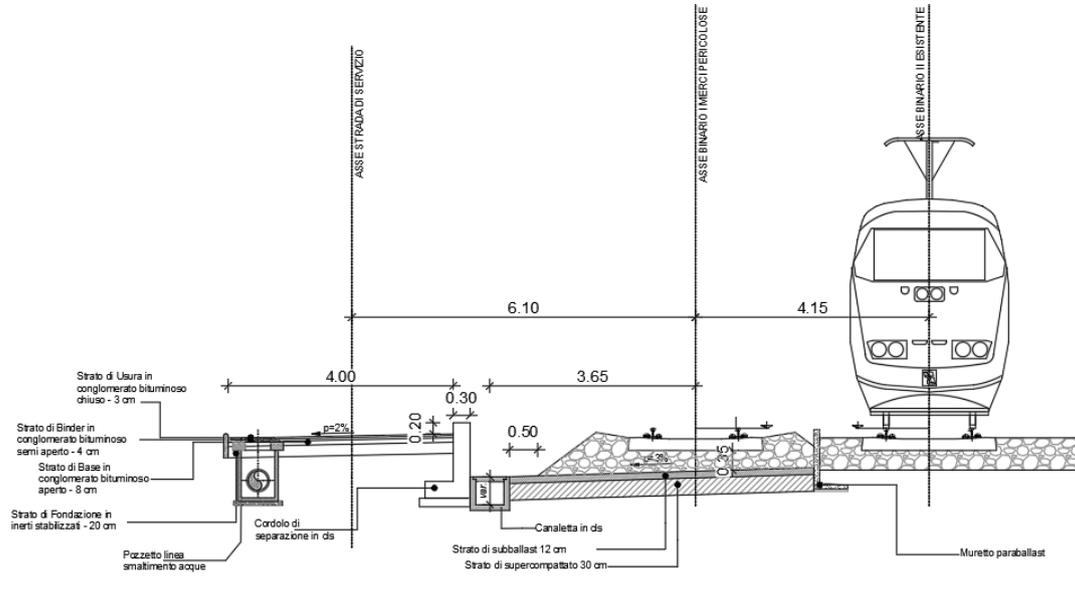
Sezione tipologica drenaggio viabilità NV04
